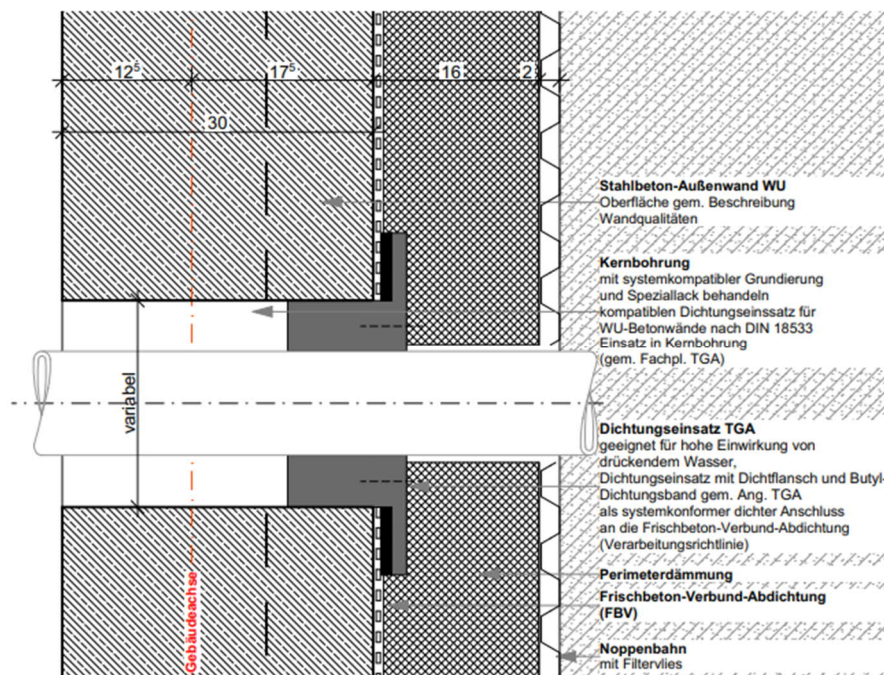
Leitdetail Rohrdurchführung mit Dichtmanschette
